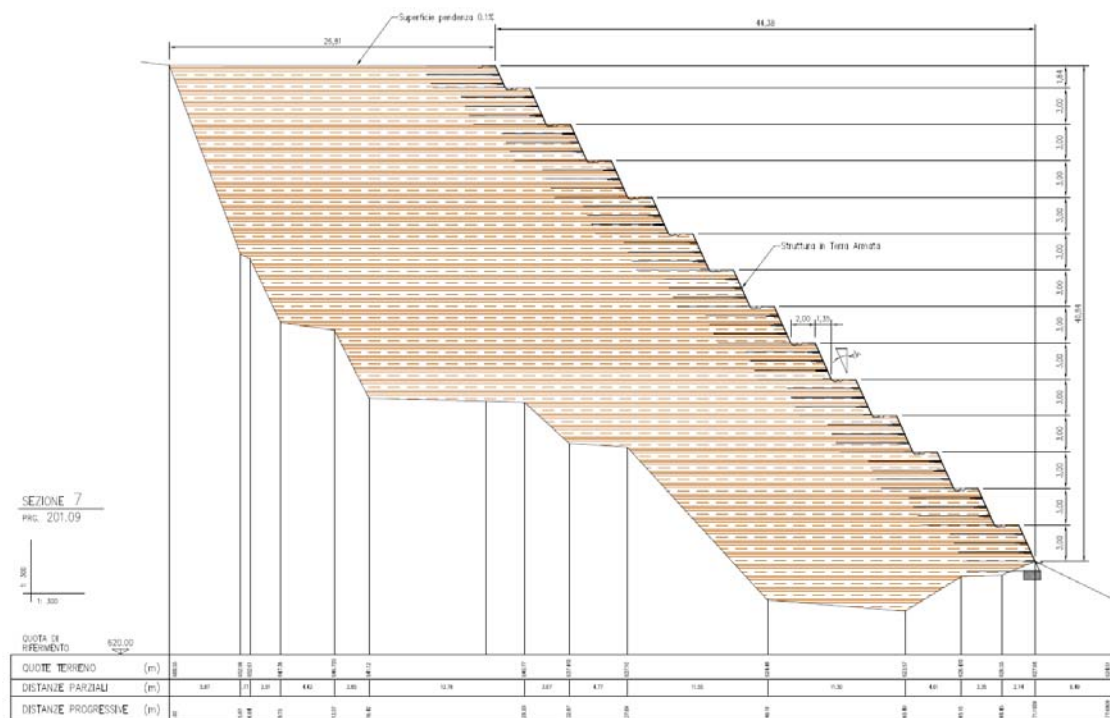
a: Sezione Tipo della Sistemazione Strutturale del Rilevato
